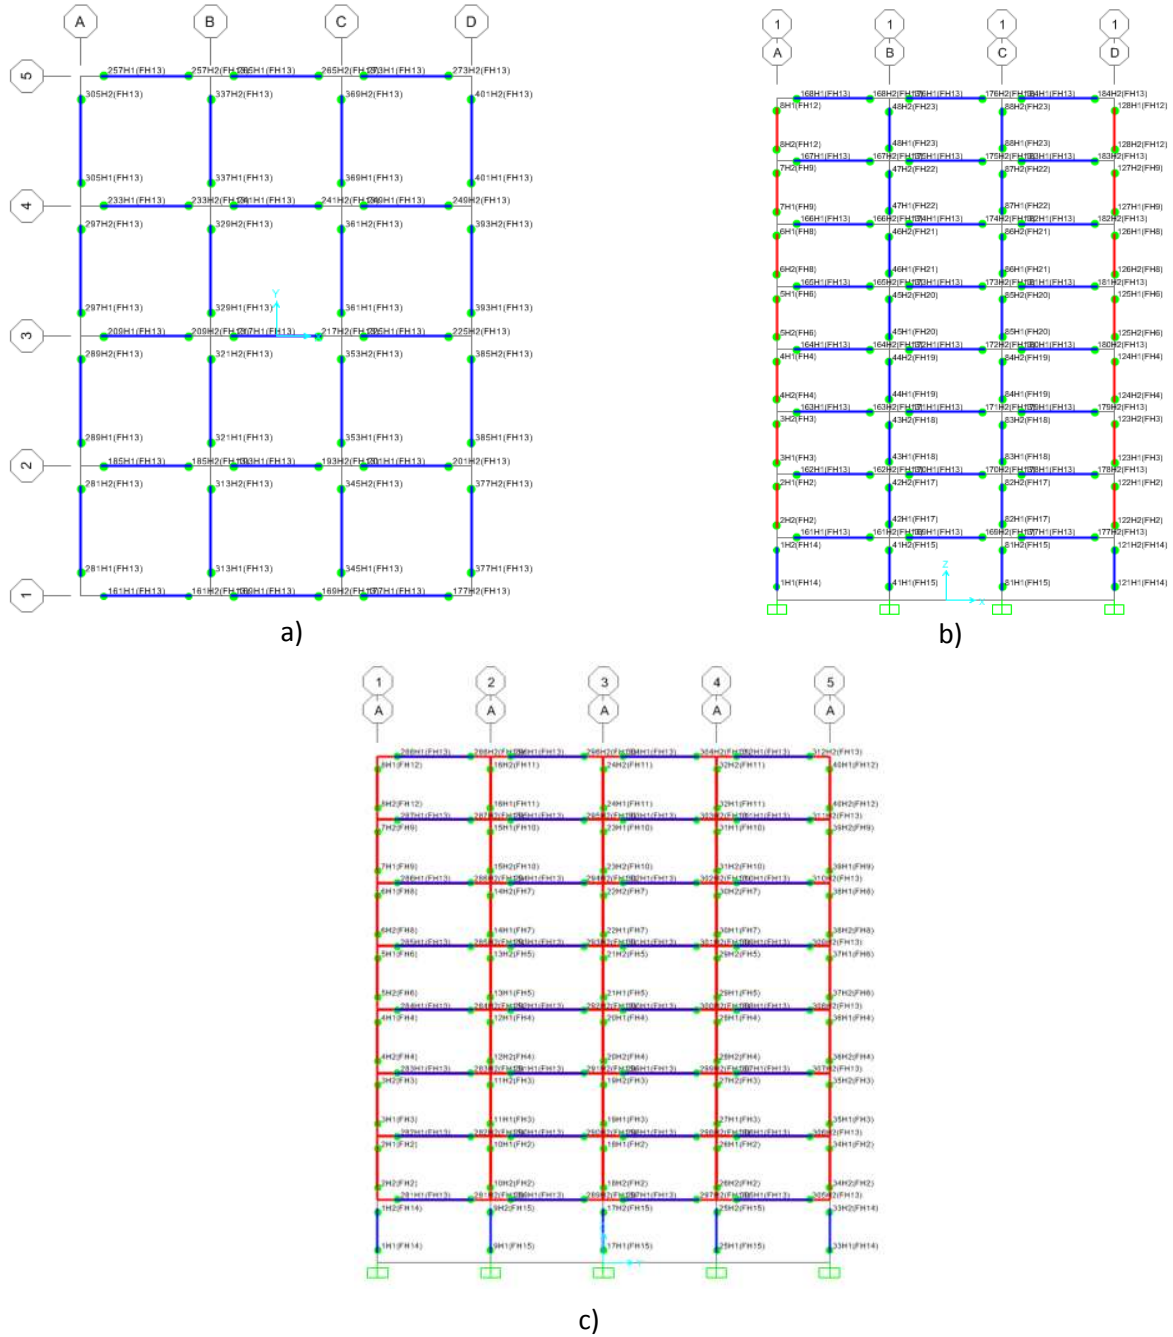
Articulaciones plásticas: a) planta b) dirección X c) dirección Y
